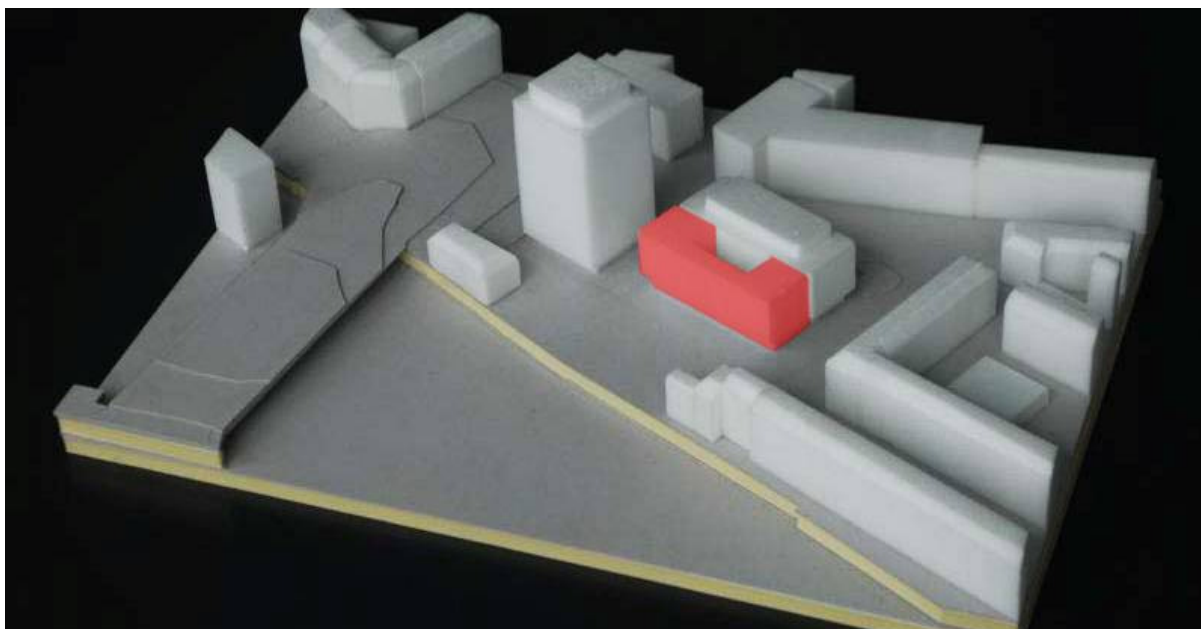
Situation mit Erweiterungsbau. Modellbild
